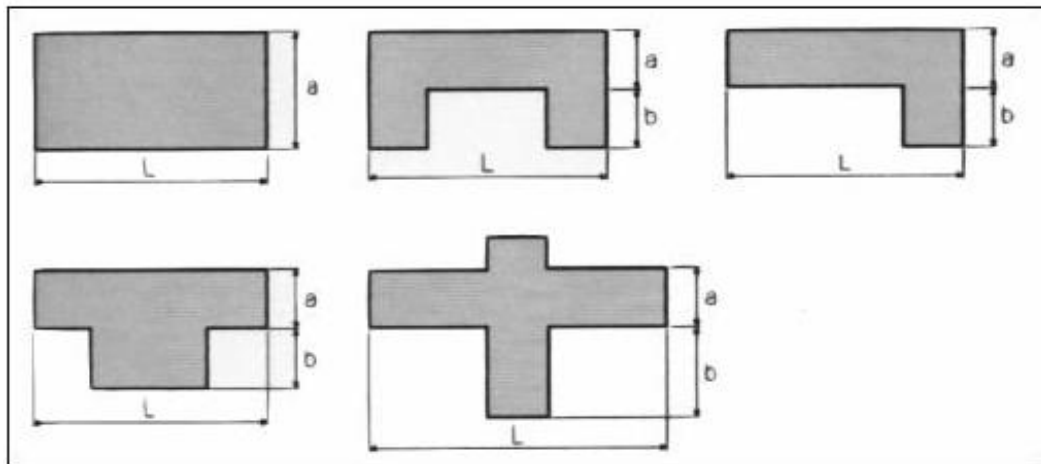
Configuración en planta de la estructura – Chavarría (2001)
